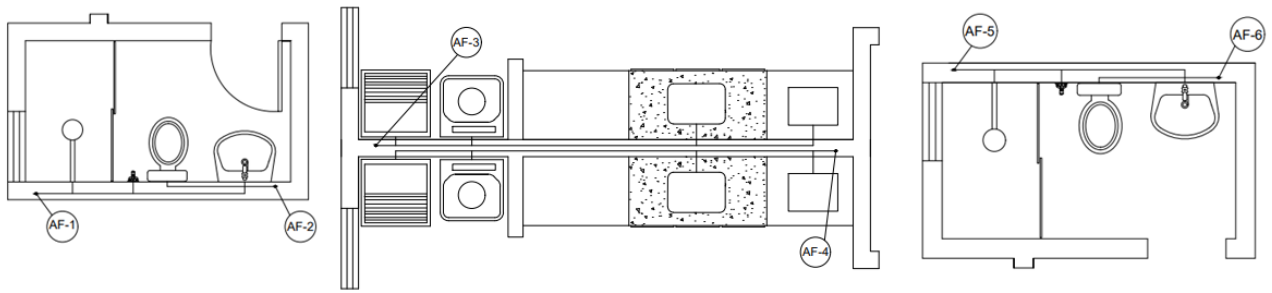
Traçado em planta dos ramais e sub-ramais abastecidos pelas colunas 1,2,3,4,5 e 6.
